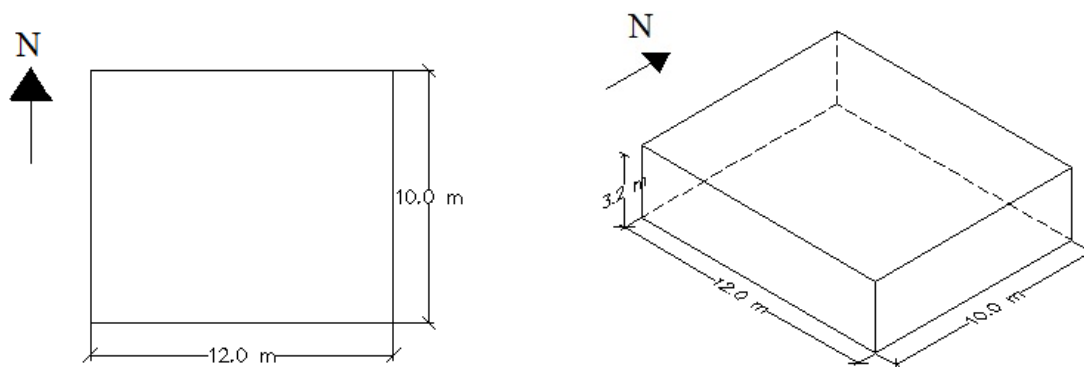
Planta e visualização tridimensional da geometria da habitação
